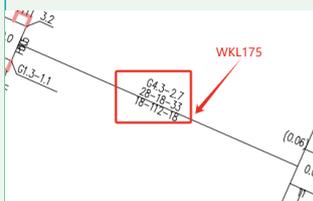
地下室顶板混凝土构件配筋简图 (局部截图)
